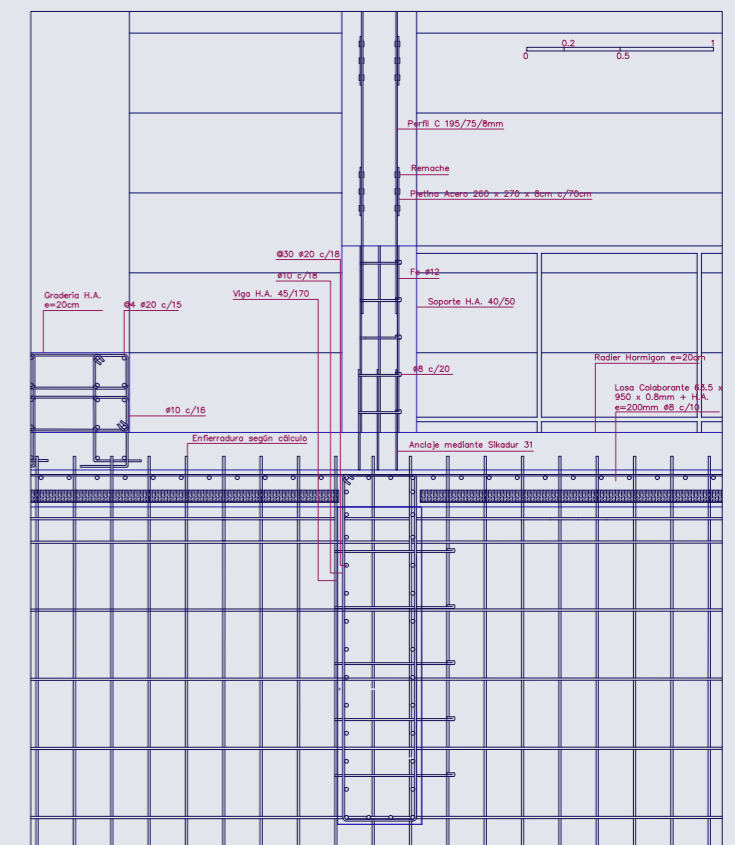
Detalles constructivos. Fuente: Elaboración propia
